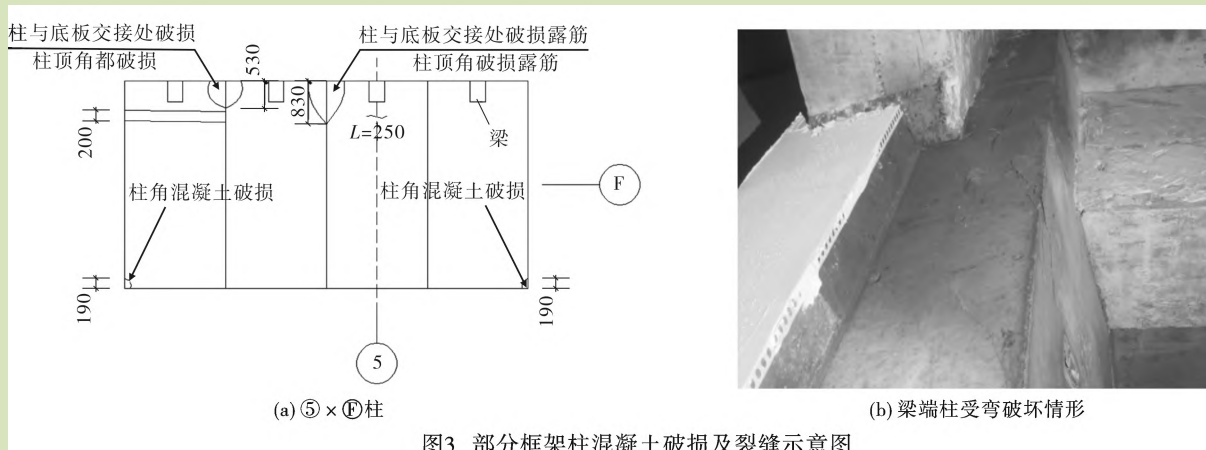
部分框架柱混凝土破损及裂缝示意图
